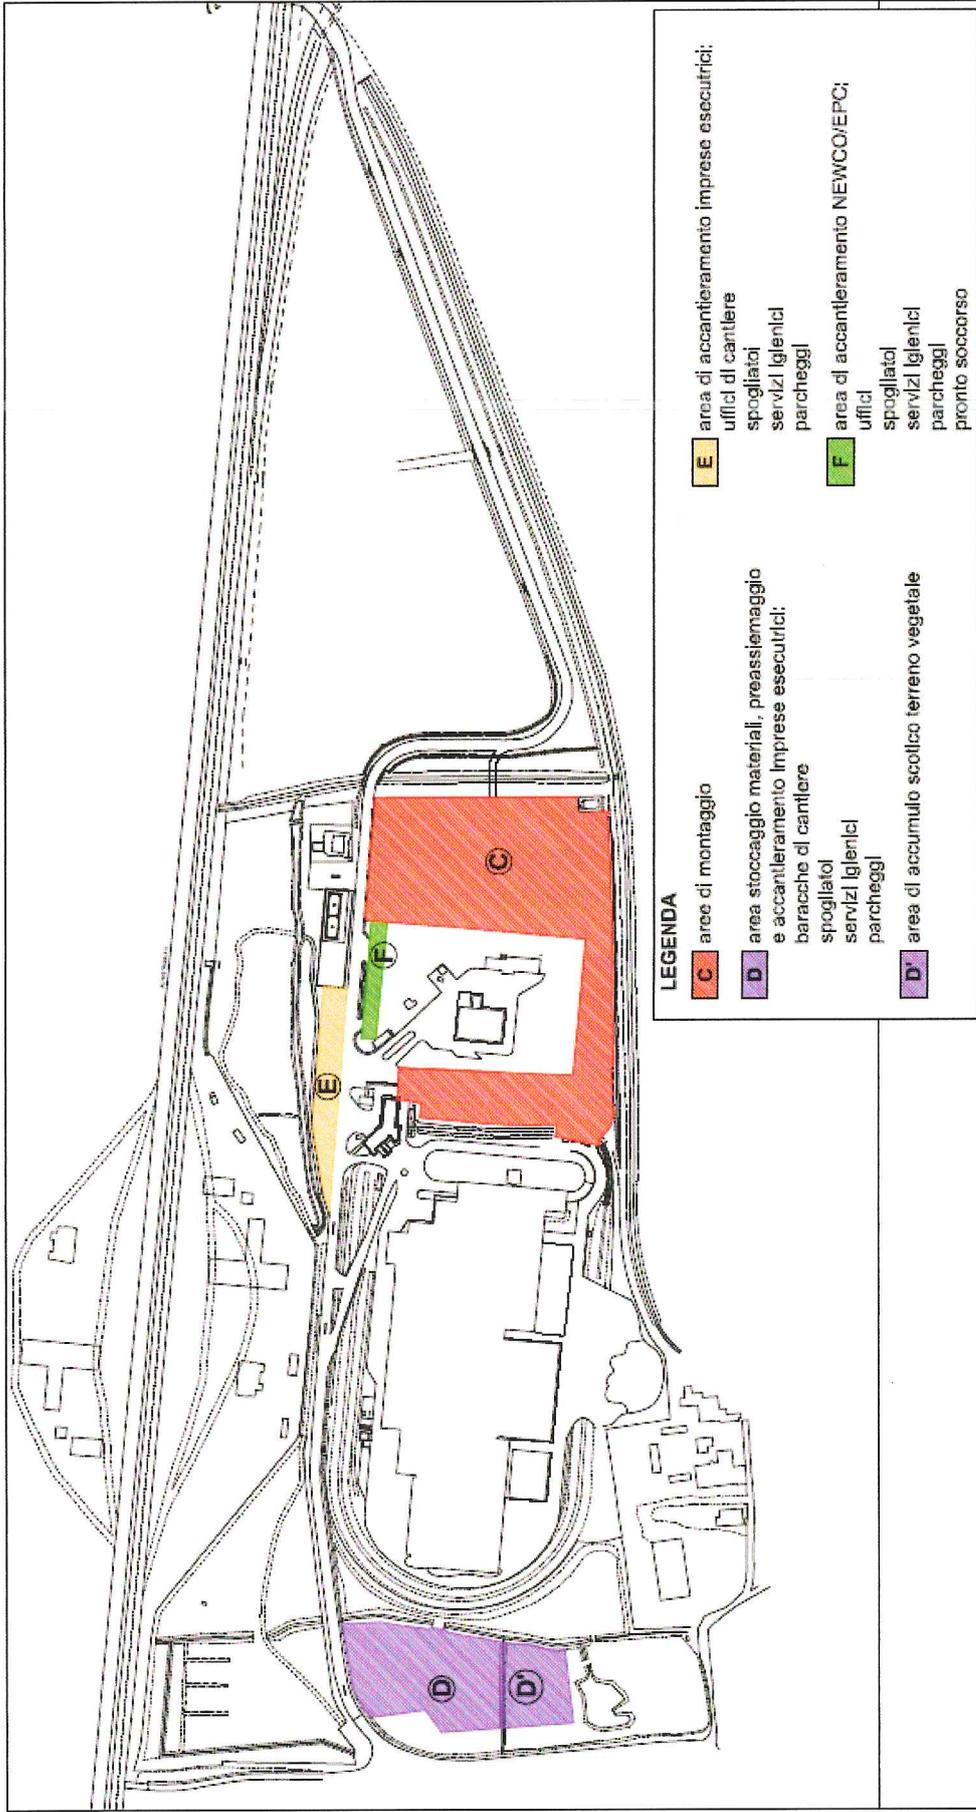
Individuazione aree di cantiere (straicio della Tavola GEN 010 – Planimetrie aree di cantiere – Aree di cantiere)
